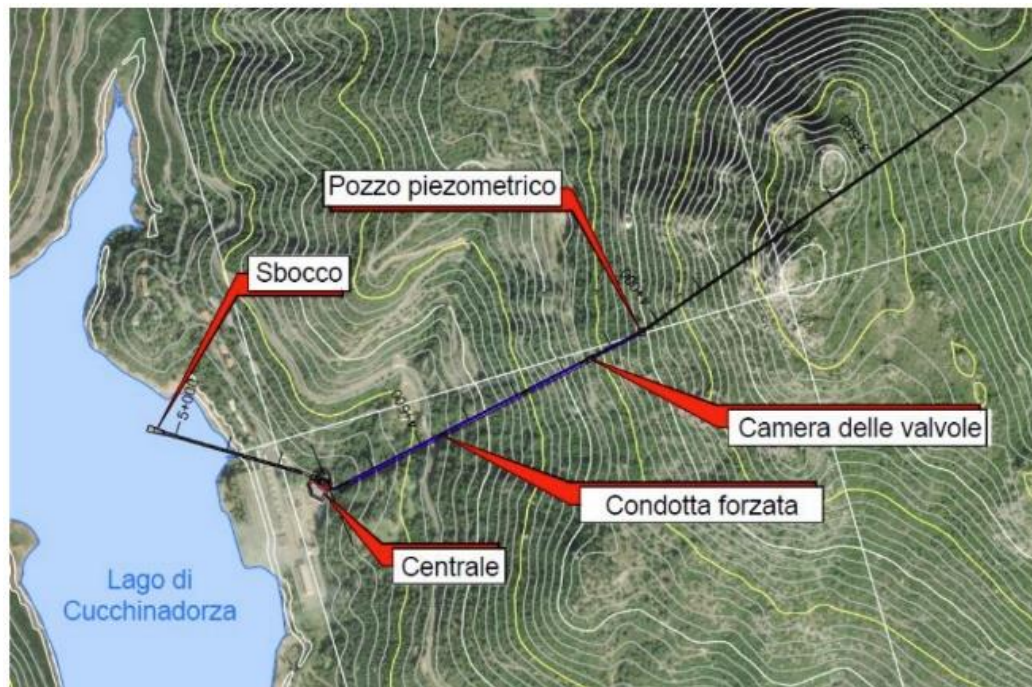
localizzazione dell'area oggetto dell'intervento, particolare.
